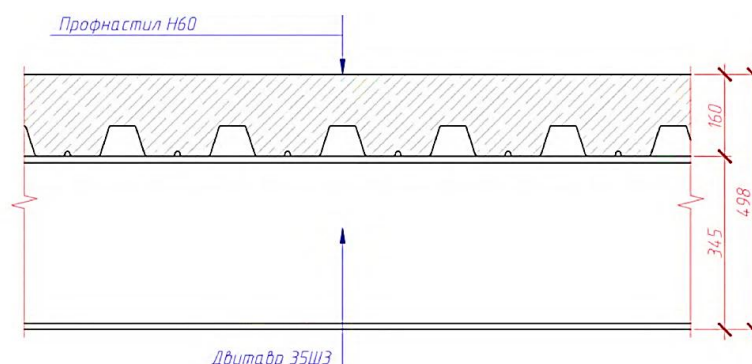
Перерізи сталезалізобетонного перекриття
